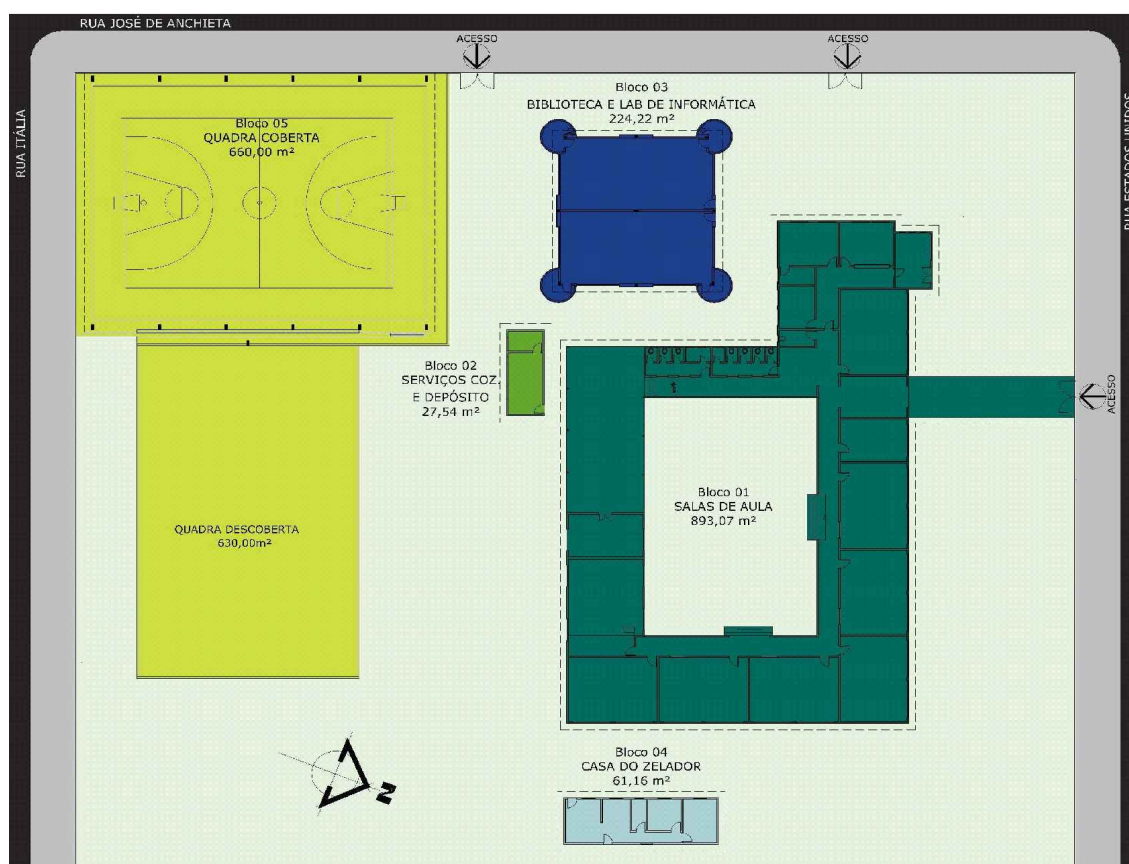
Planta Baixa Colégio Estadual Rainha da Paz
